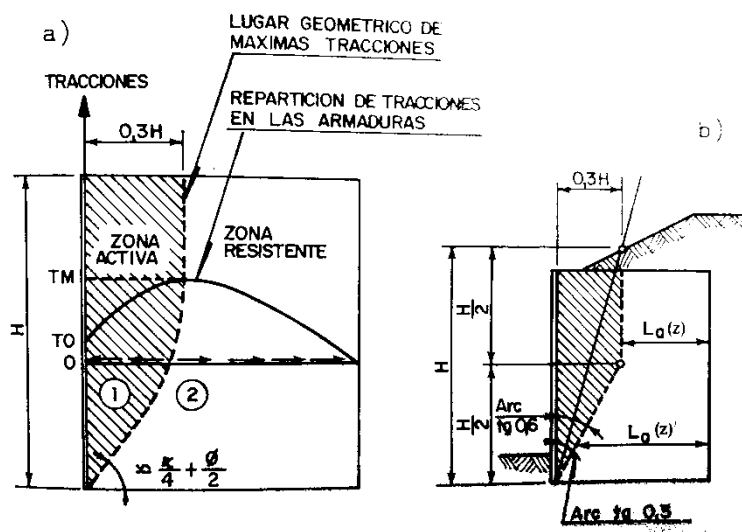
Distribución de tensiones tangenciales en las tiras un muro de tierra armada.
